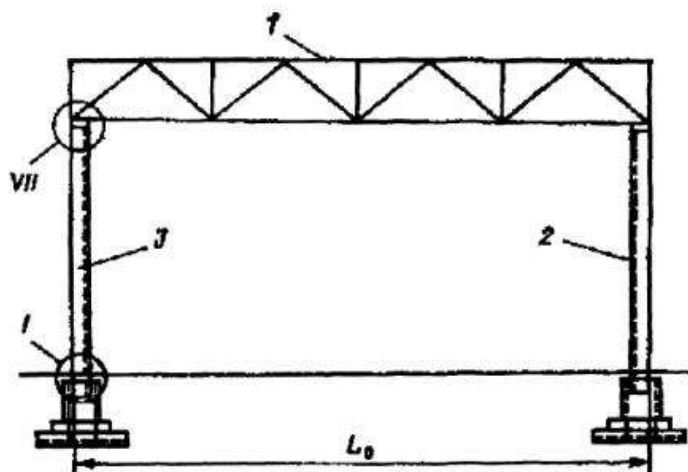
Объединение каркаса здания с помощью стальных ферм:
